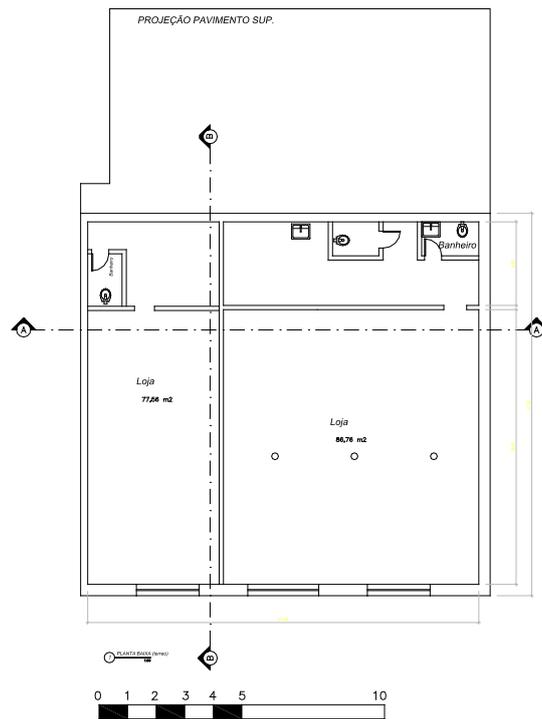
Planta primeiro pavimento - Casa Leni Ayub
